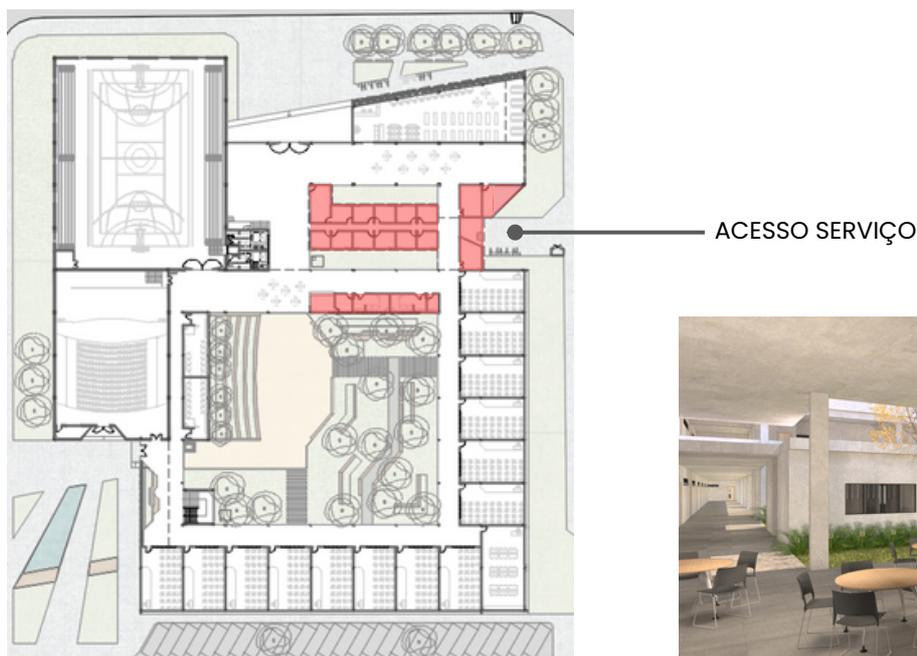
Planta baixa do térreo com localização das áreas de administração e serviços, destacada em vermelho. Fonte: Autoria própria.
